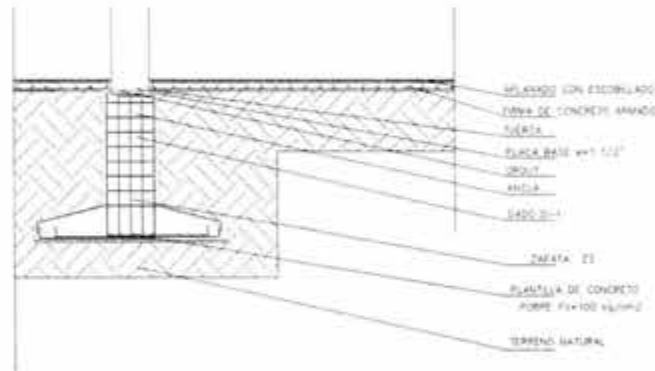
Detalle estructural, en plano de corte por fachada.
